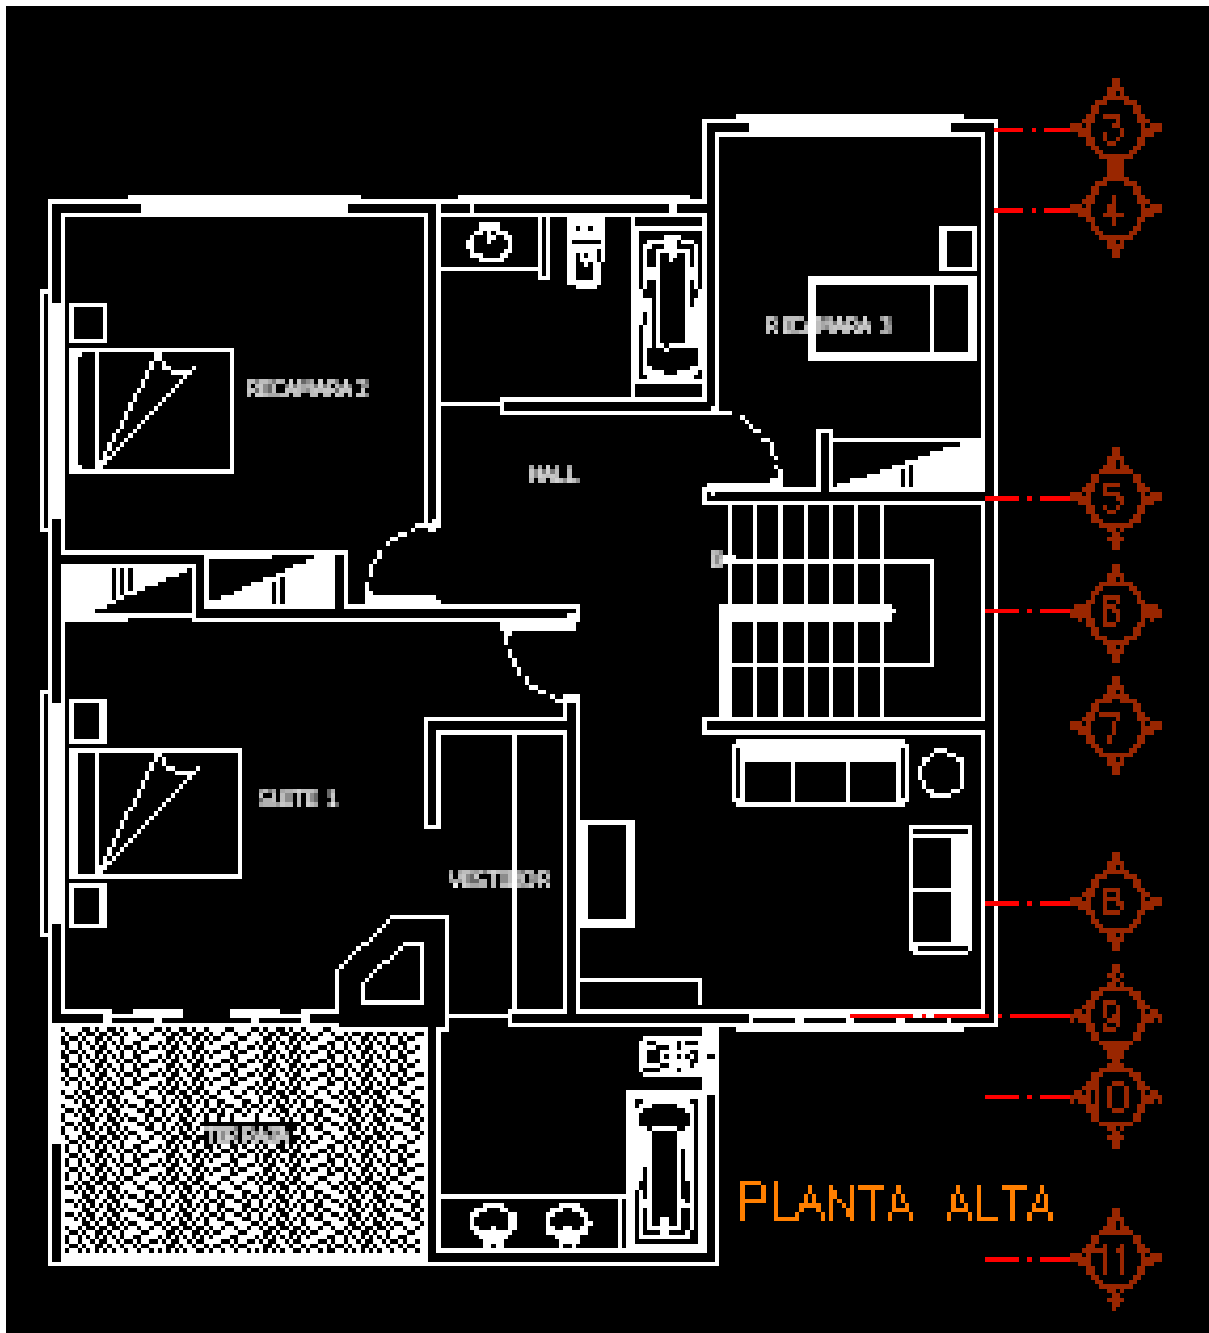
b) Plano de la casa a digitalizar: planta alta
